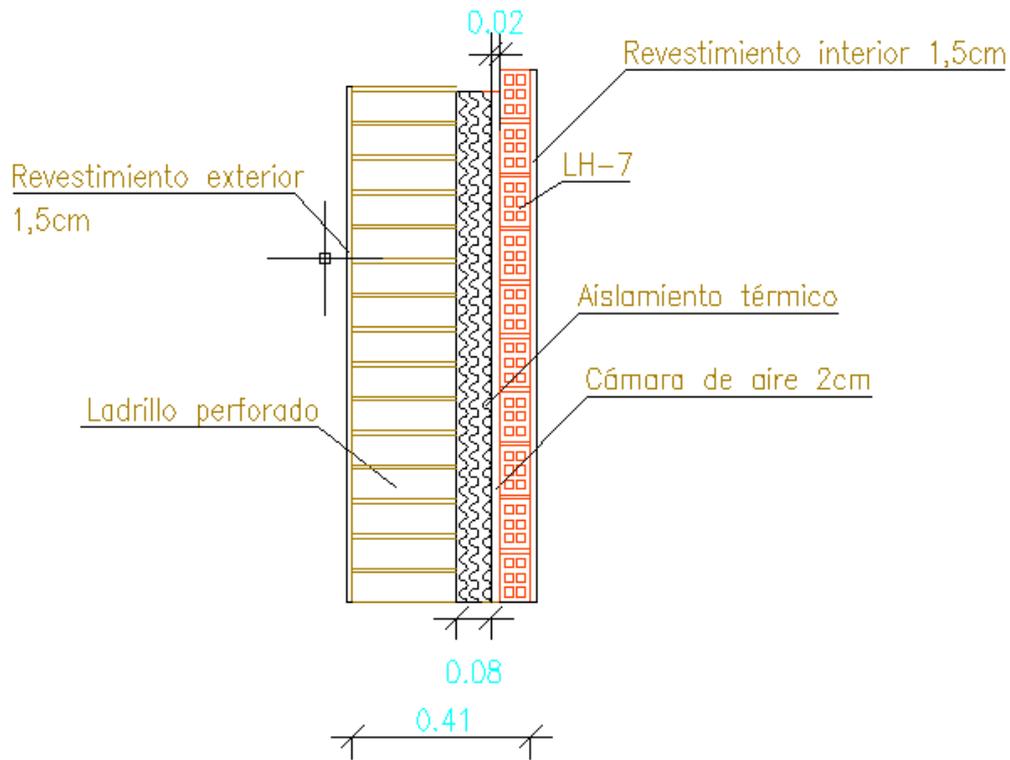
Detalle constructivo del muro exterior con la solución propuesta.
